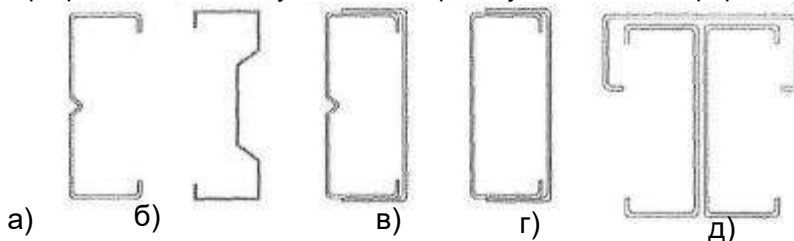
Рекомендовані перерізи елементів для конструкції ферми покриття: С-подібний переріз з продольним ребром жорсткості (а);  $\Sigma$  -профіль (б); в- складений переріз із С-подібного профілю з продольною гофрою і П-профілю; складений переріз із С-профілю та П-профілю (г); складений переріз поясів (д)
